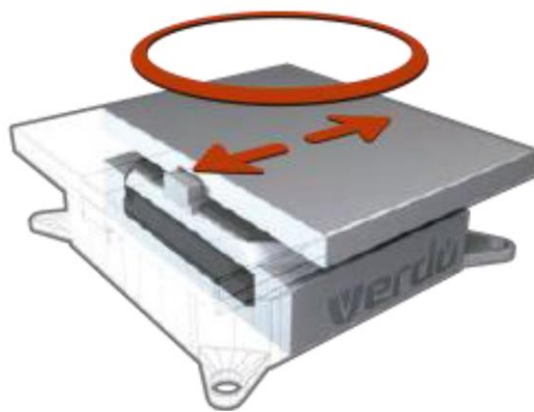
Aparato POT guiado usado en el estribo 2 (Verdú)
